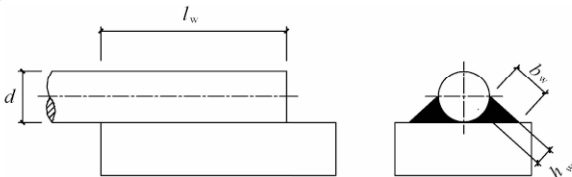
混合梁纵向受力钢筋与工字形钢接头搭接焊接头
